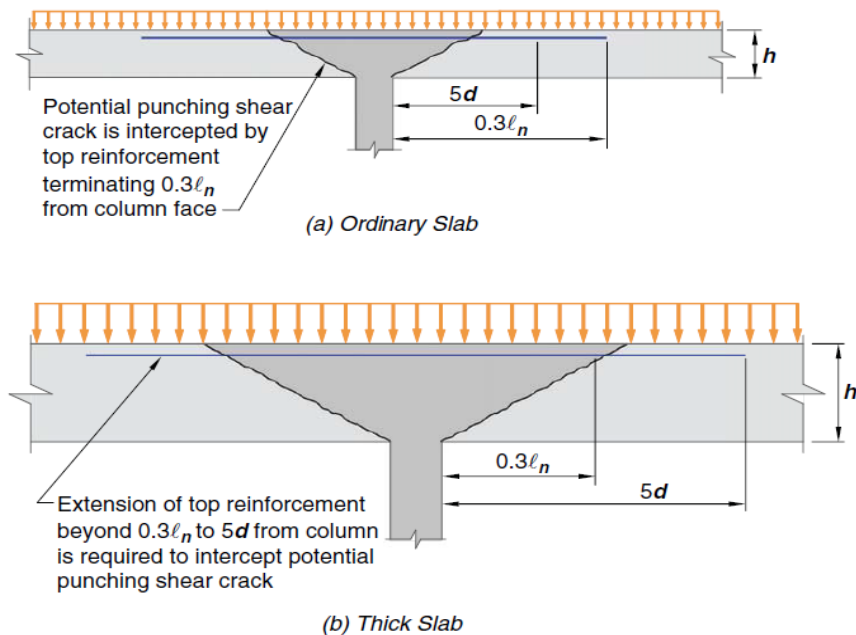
Refuerzo superior a flexión. (American Concrete Institute, 2019)
